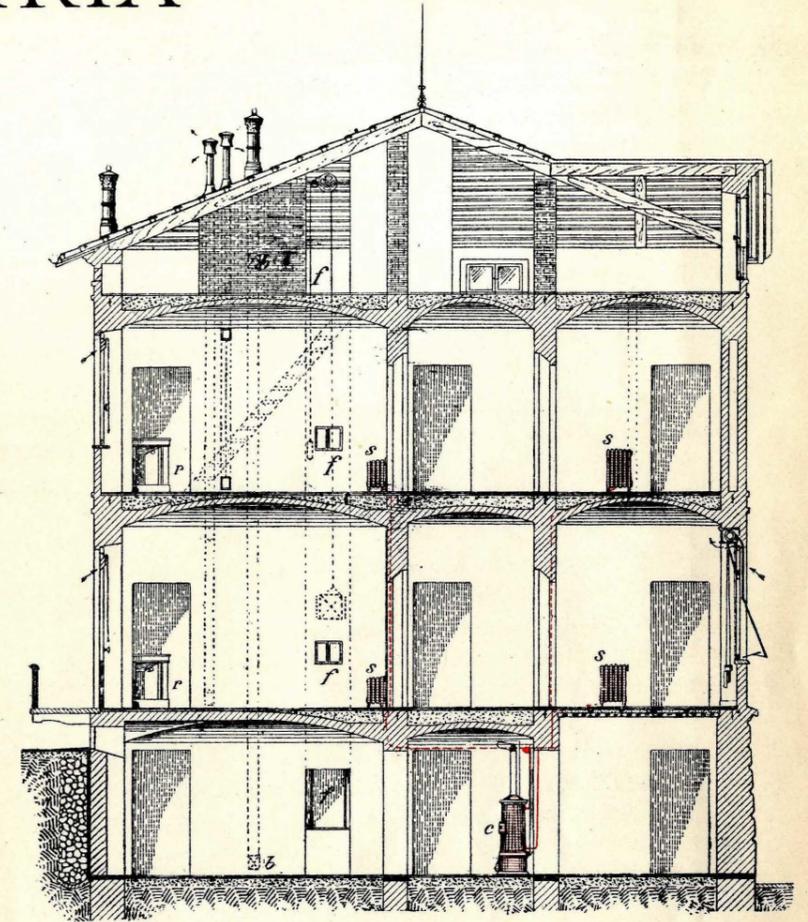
Sezione trasversale E-F (Scala 1:135).
